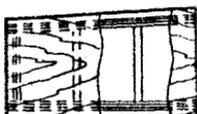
Вырыв стенки клефанерной коробчатой балки
